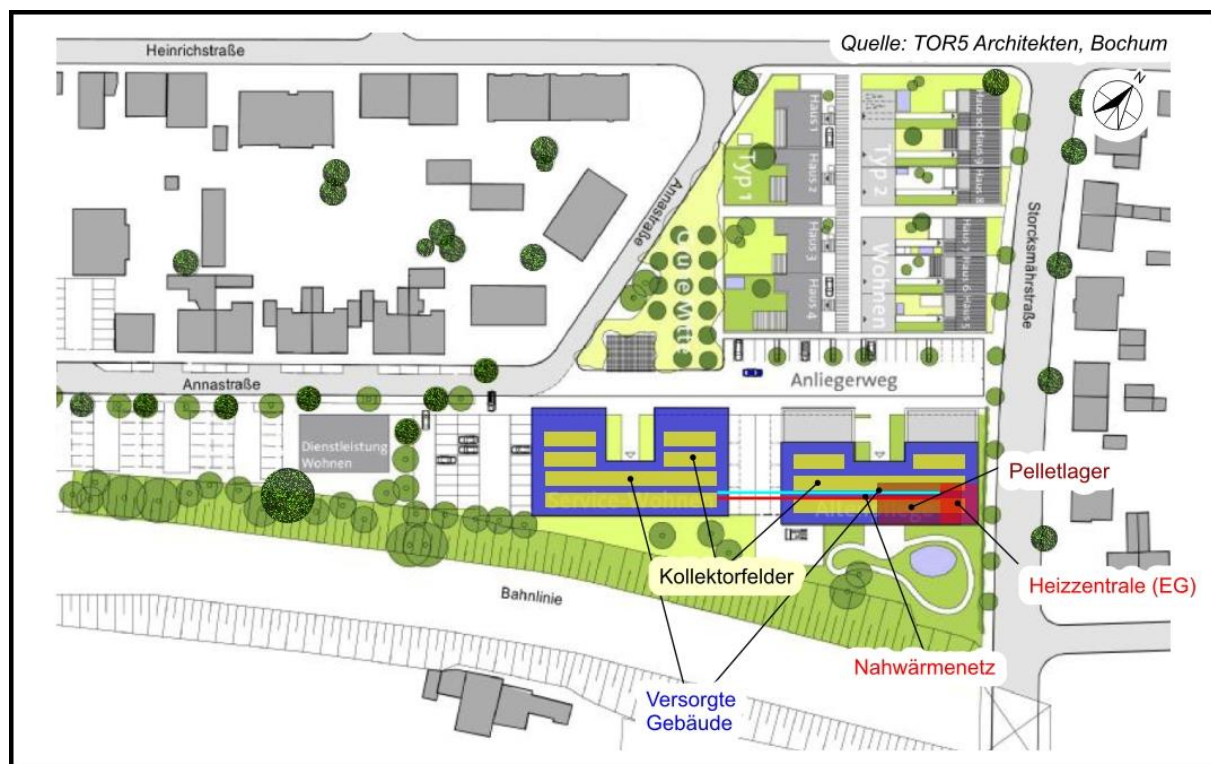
Lageplan Herten, Grüne Mitte Westerholt
